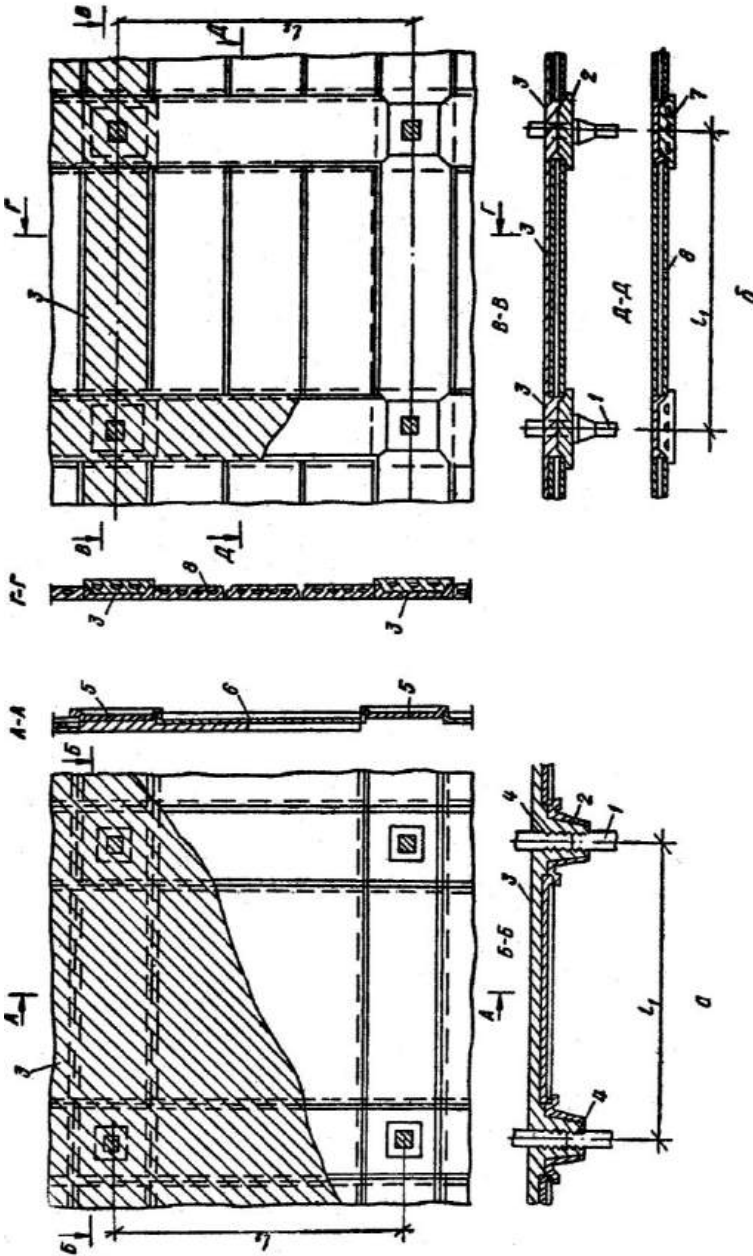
Збірно-монолітні безбалкові перекриття: *a* – з ребристих плит; *б* – з порожнистих; *1* – колони; *2* – капітелі; *3* – бетон замоноличування; *4* – бетонні шпонки; *5* – міжколонна ребриста плита; *6* – прольотна ребриста плита; *7* – порожниста міжколонна плита; *8* – прольотна порожниста плита
